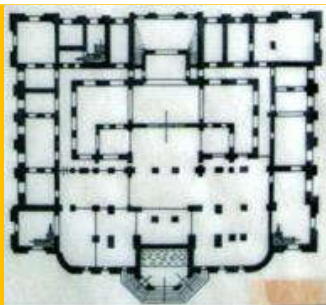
Topo à esquerda*: Planta baixa do porão. *Topo e Meio*: Planta baixa do térreo.
